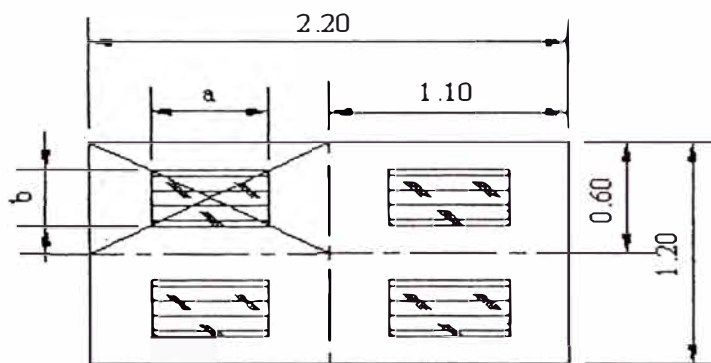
DIVISION EN SECTORES SIMETRICOS
